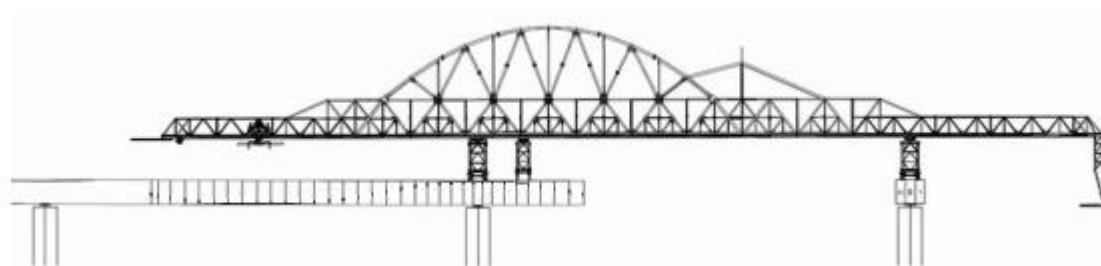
| 5 – Lançaadeira superior de aduelas apoiada diretamente nos pilares [13]
